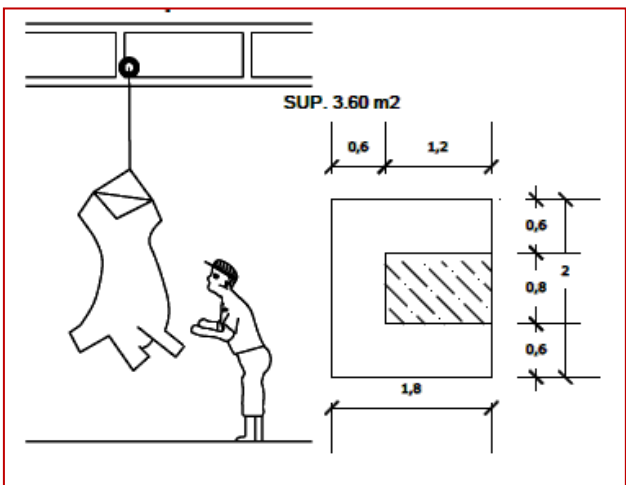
Planta y alzado en canales de carne de puerco. Fuente. Pablo Enrique Herrera Gaona. 28 octubre 2014.
